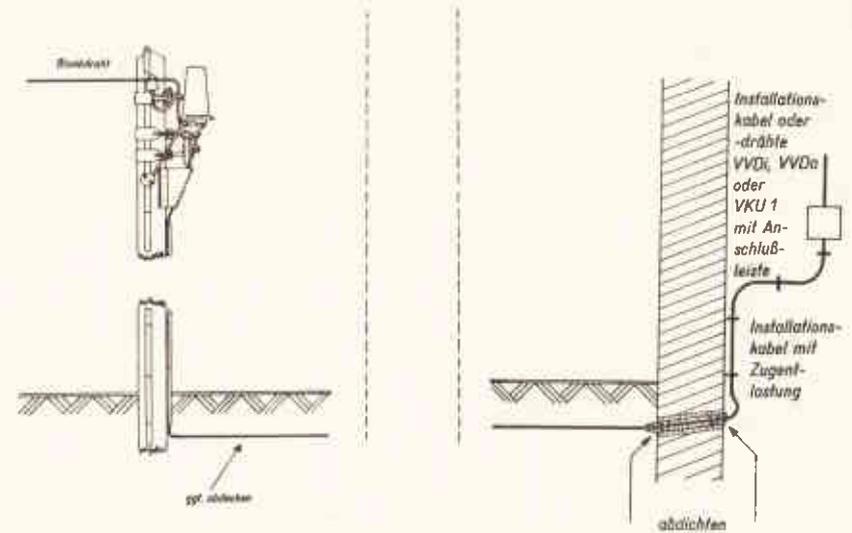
Unterirdische Einführung mit Installationskabel
